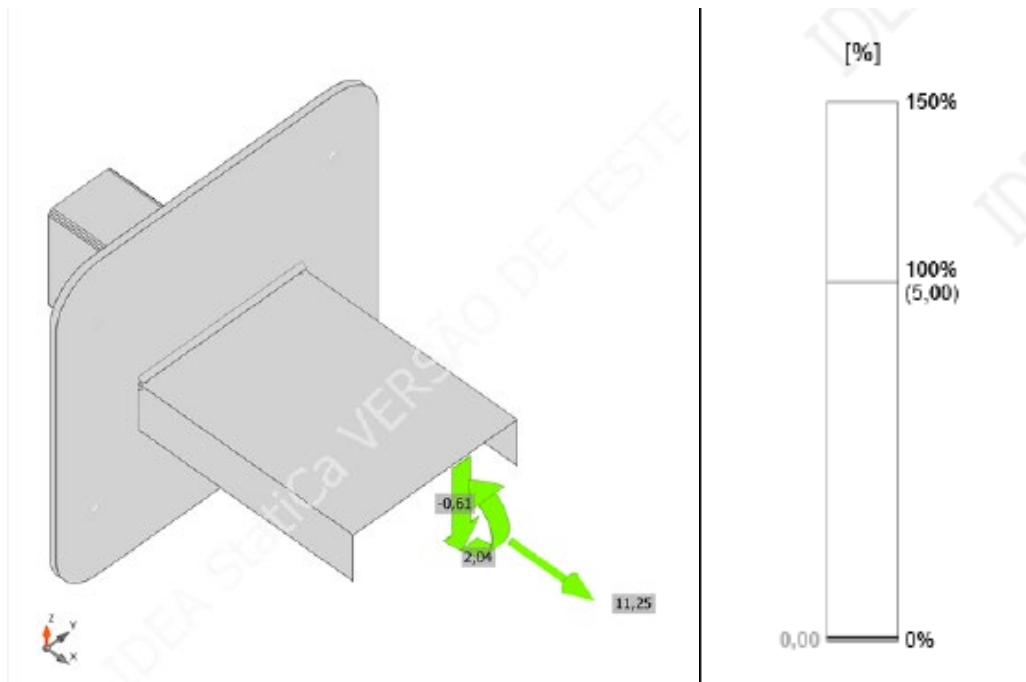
Ligação-4 Tensões submetidas (Compressão)
